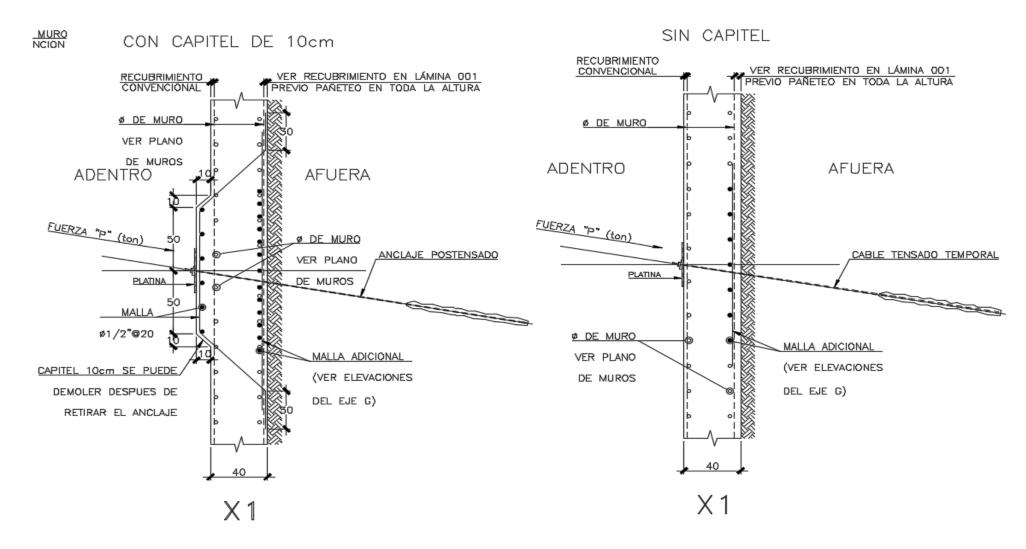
Detalle de refuerzo adicional en zona alrededor del anclaje
